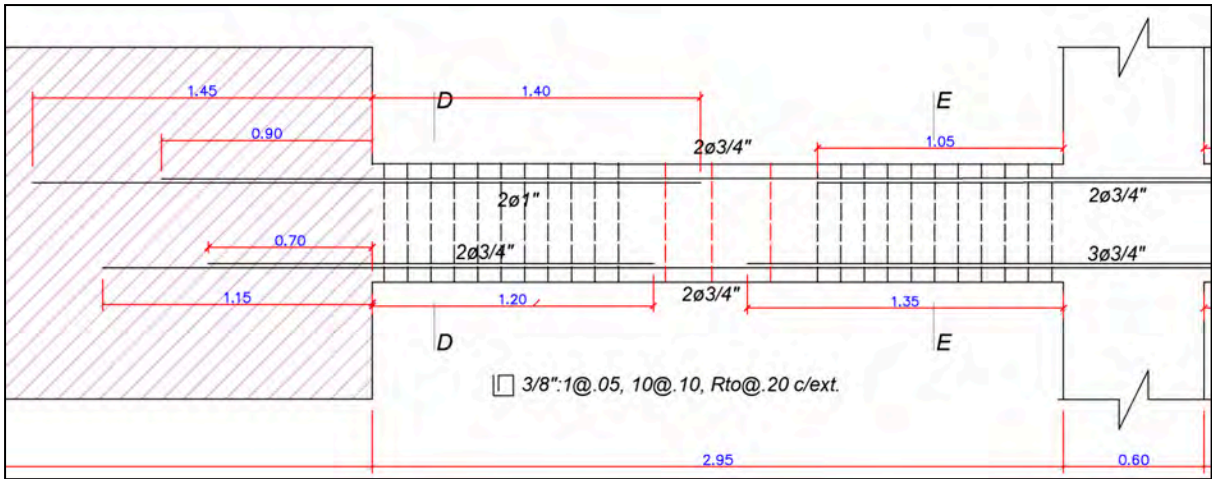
Diseño final viga V-22(Segundo tramo).(Fuente:propia)
